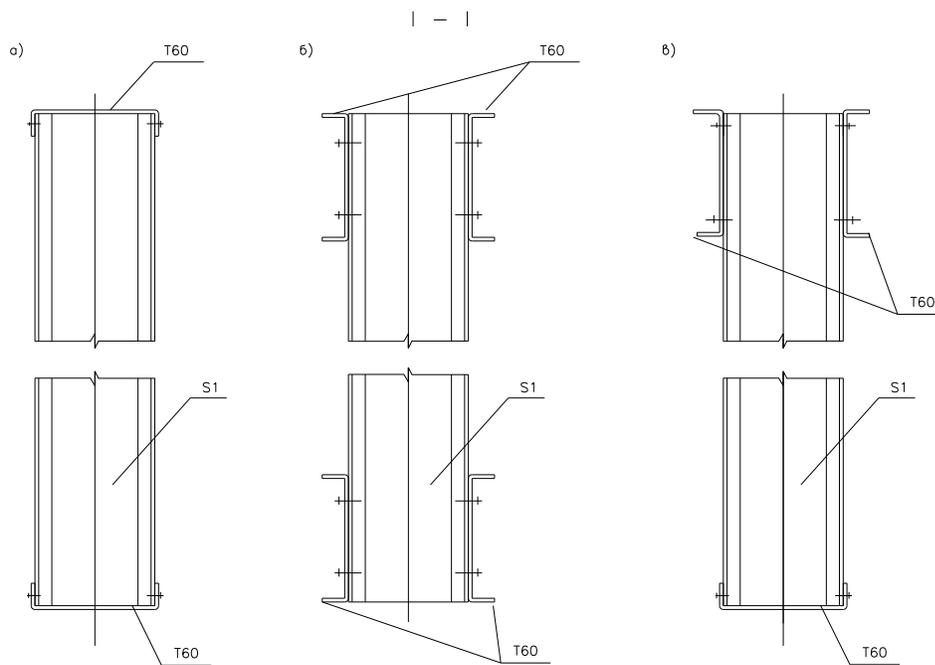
Типовые решения верхнего и нижнего пояса ферм.
